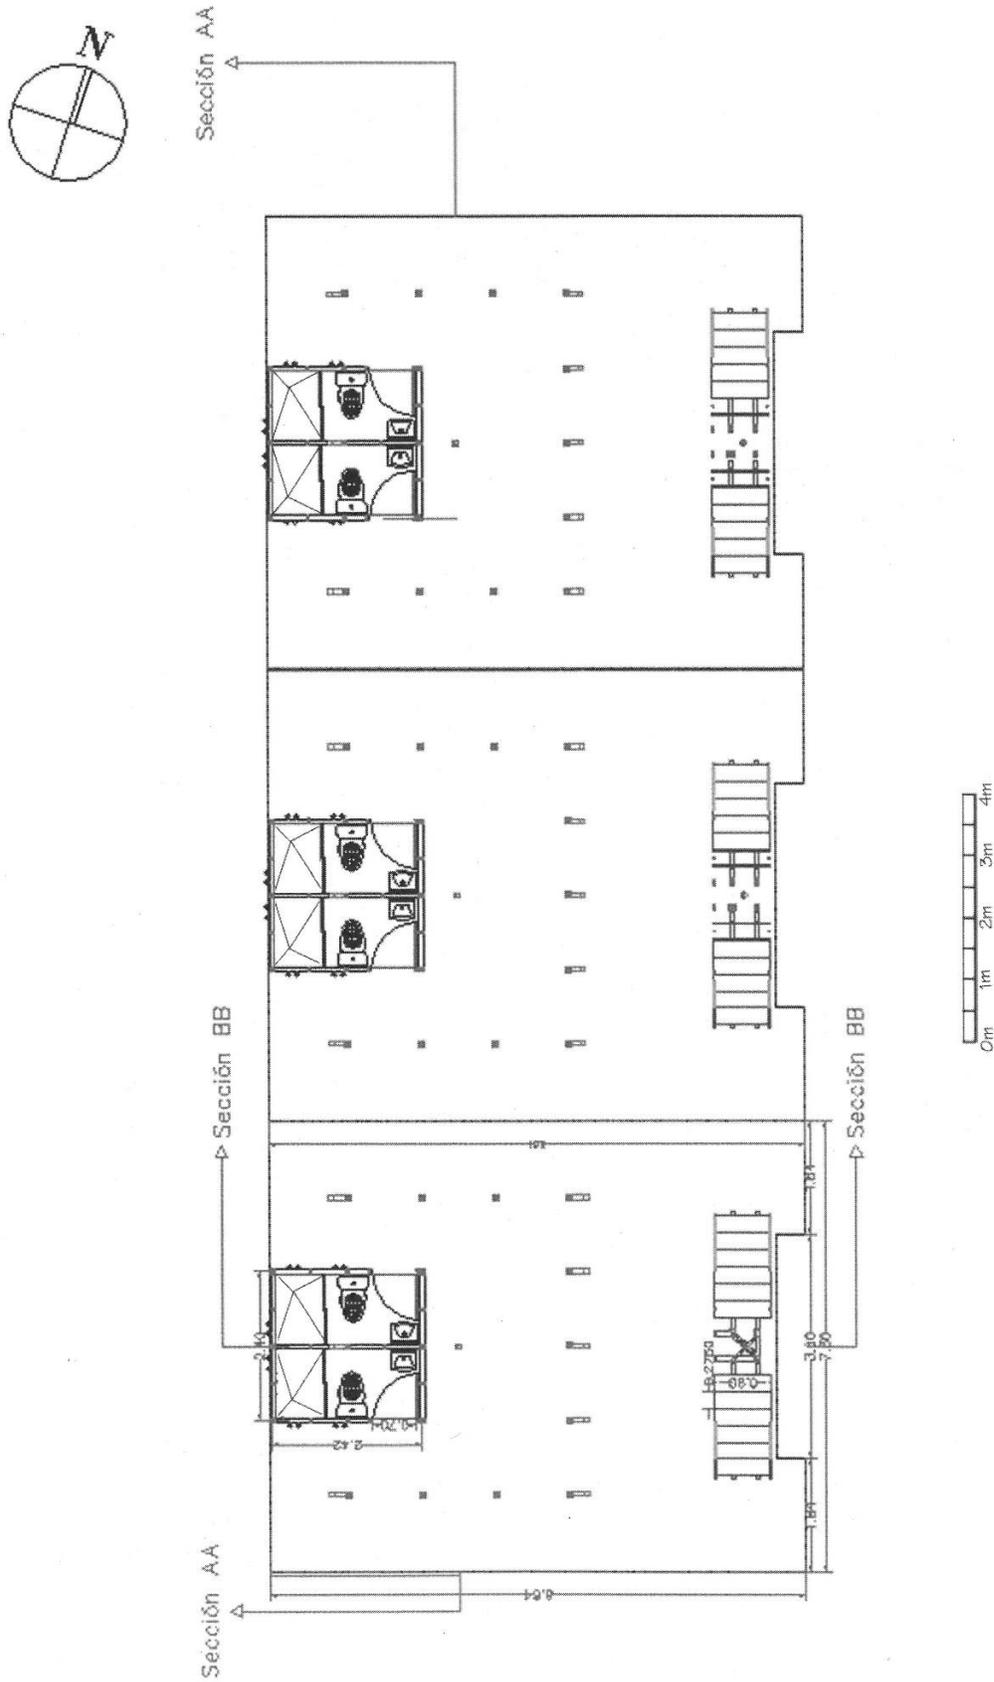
Planta primer piso. Propuesta casa Bache IAT
